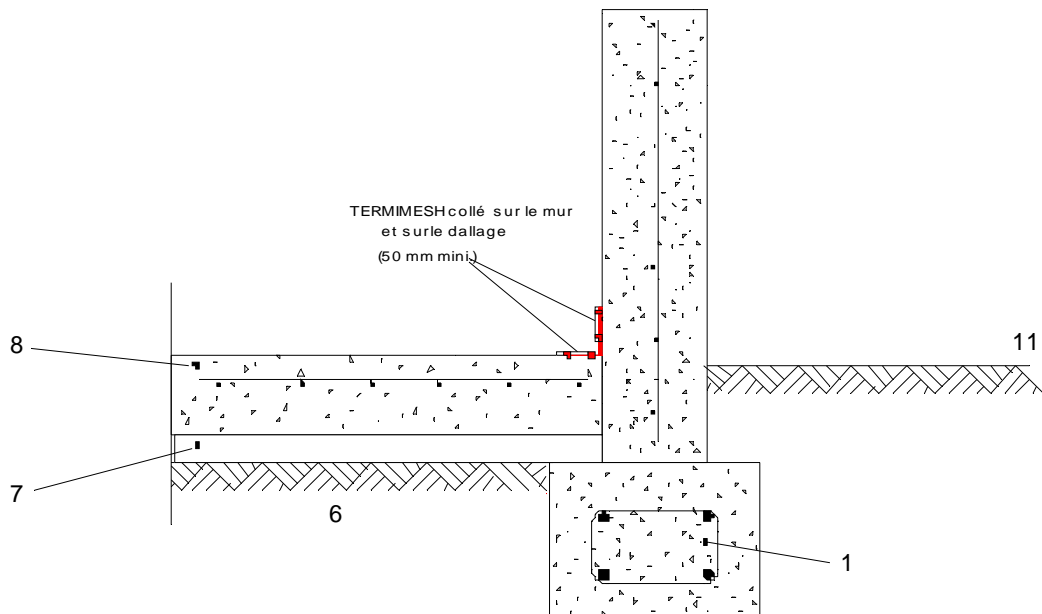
EU 1.3-2 : dallage désolidarisé et mur banché, pose après coulage
